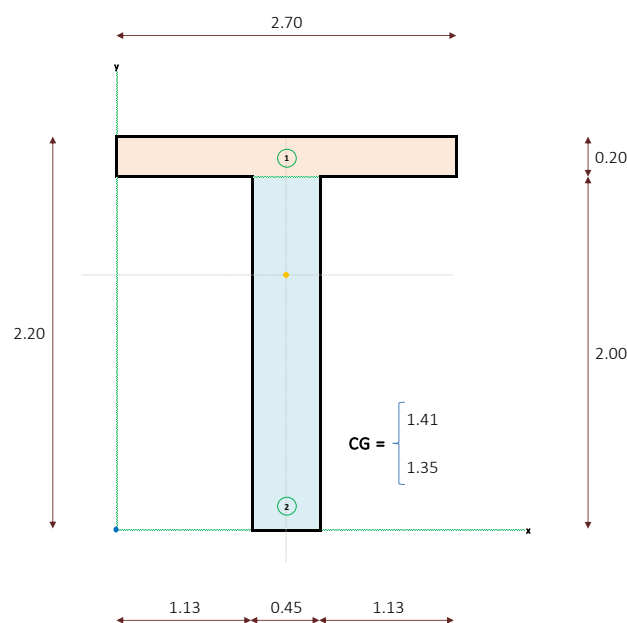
Sección T viga de hormigón del puente Cebadas.
